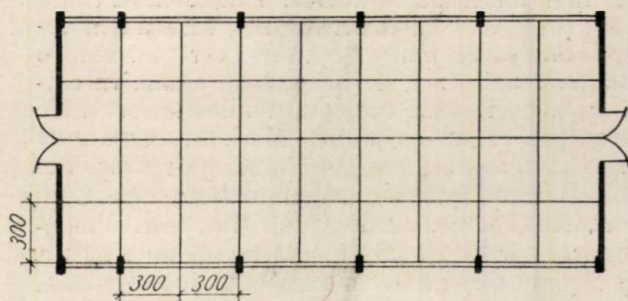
Schema de plan a unei hale proiectată pe modul.
